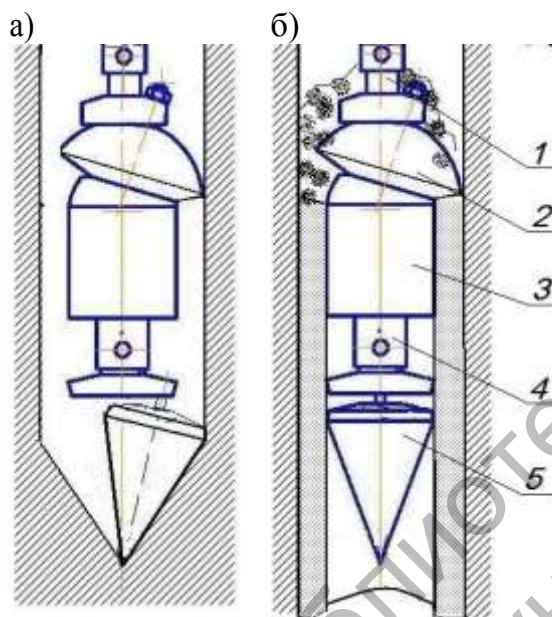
Рабочий орган для изготовления полых буронабивных свай
